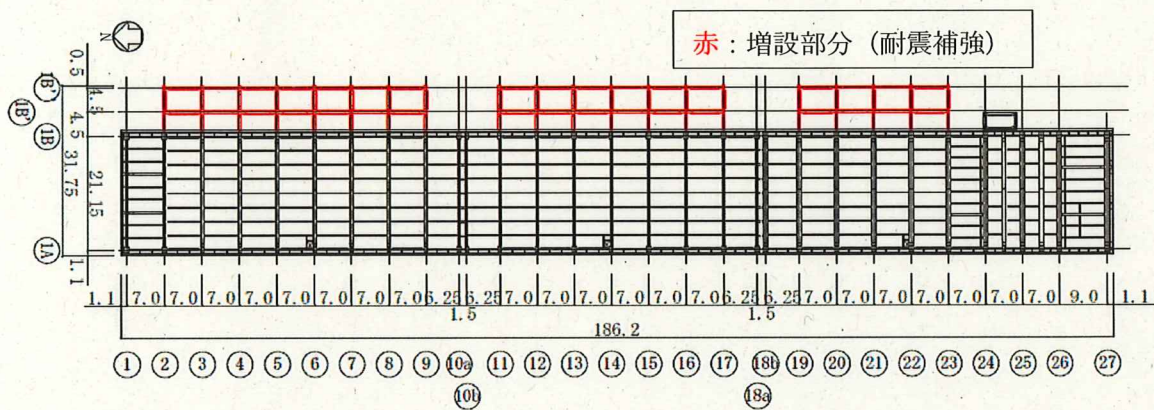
(3) 2階平面図 (G.L. +16.650) (単位 : m)
